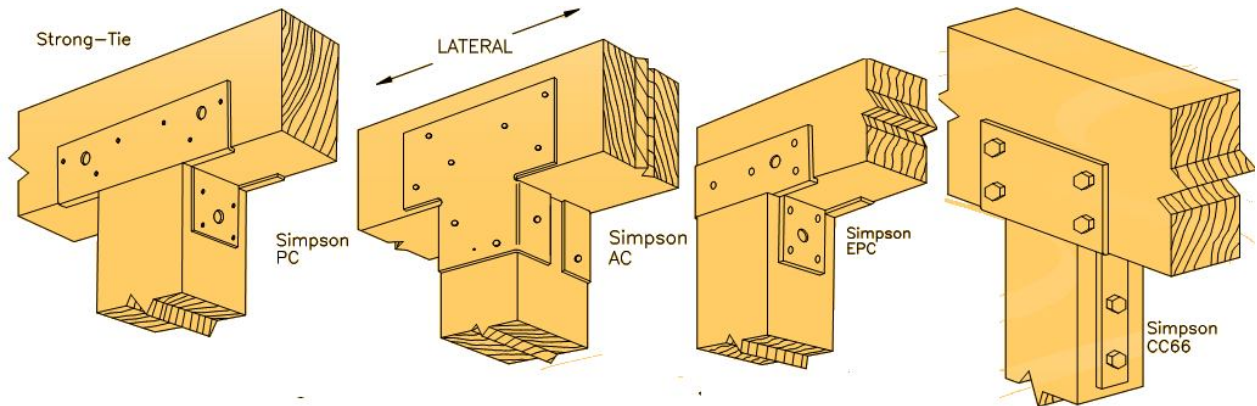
Conectores Unión Poste-Viga o Columna-Viga.
